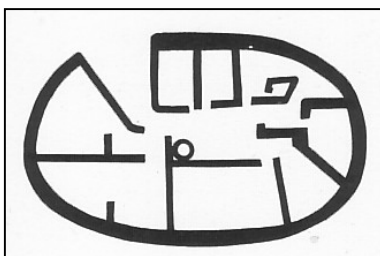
Plantas de casa antigua en Creta, donde al igual que en el resto de Grecia estaba muy difundida la forma ovoidal. Fuente: Camesasca 1971, p.47.
